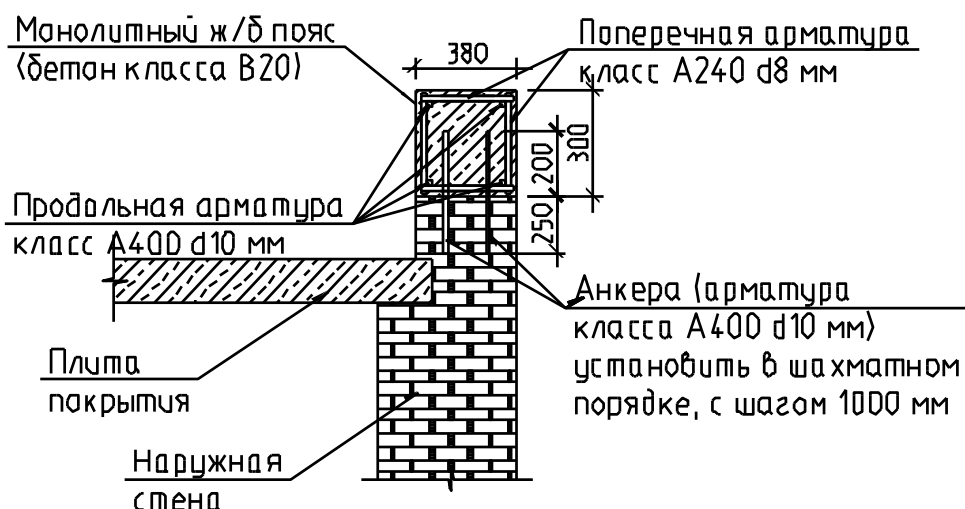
Схема усиления парапета монолитным железобетонным поясом
